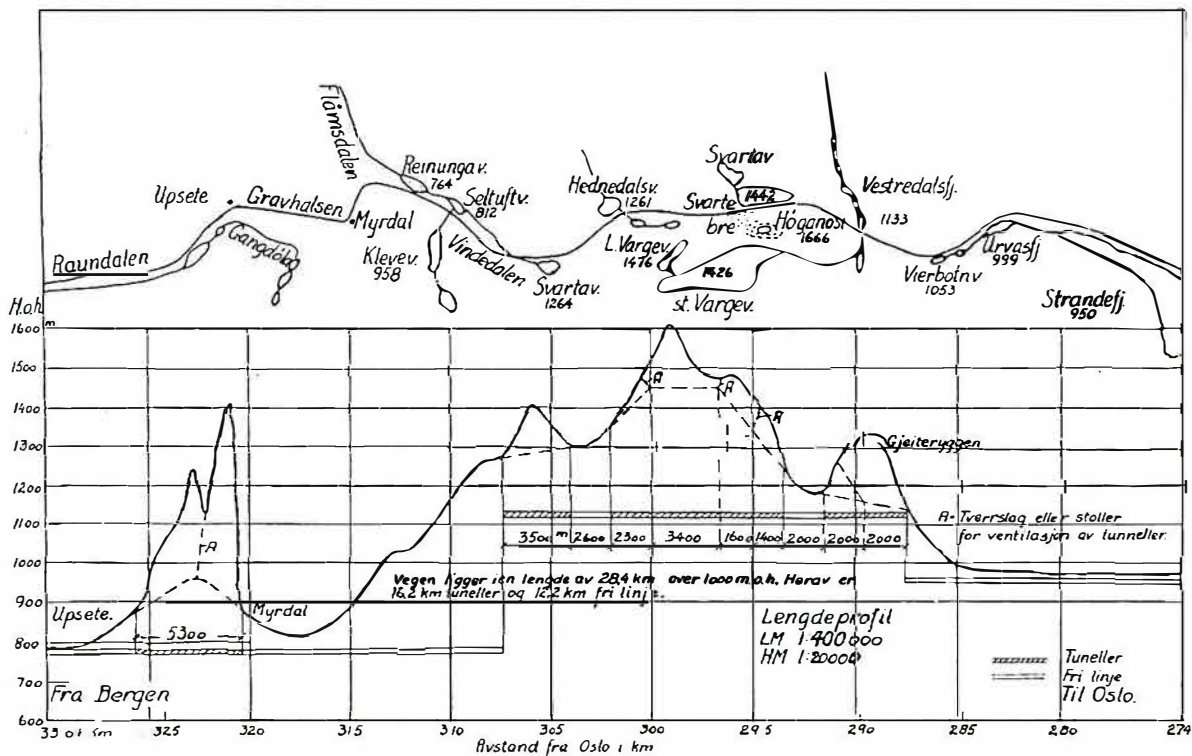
Lengdeprofil for høyfjellsovergang Strandefjorden—Raundalen.
